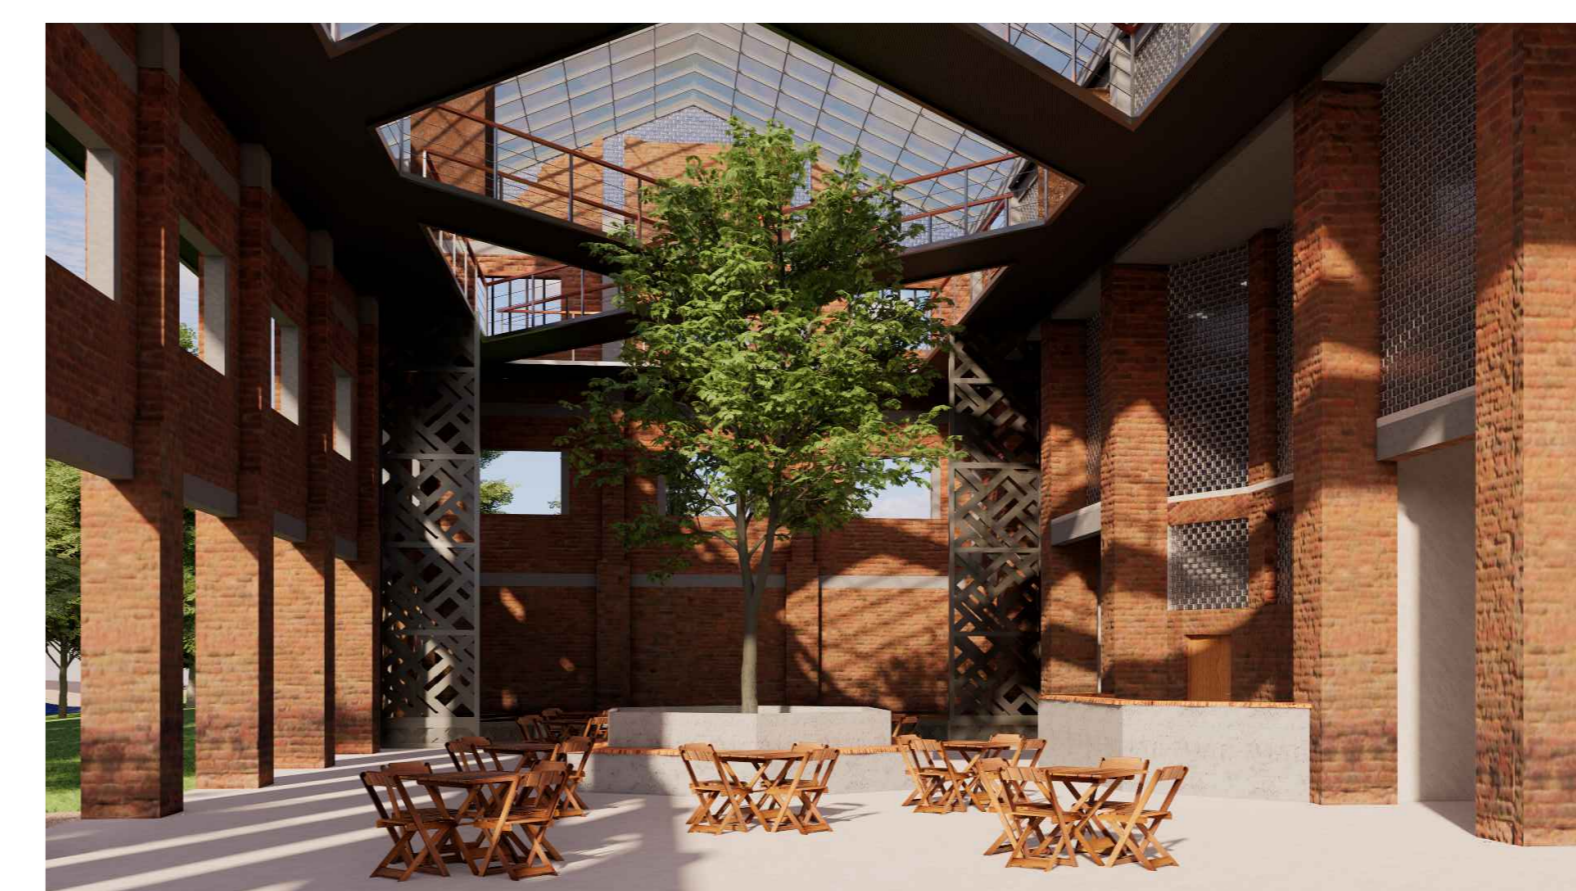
IMAGEM RESTAURANTE - PAVIMENTO TERREO
